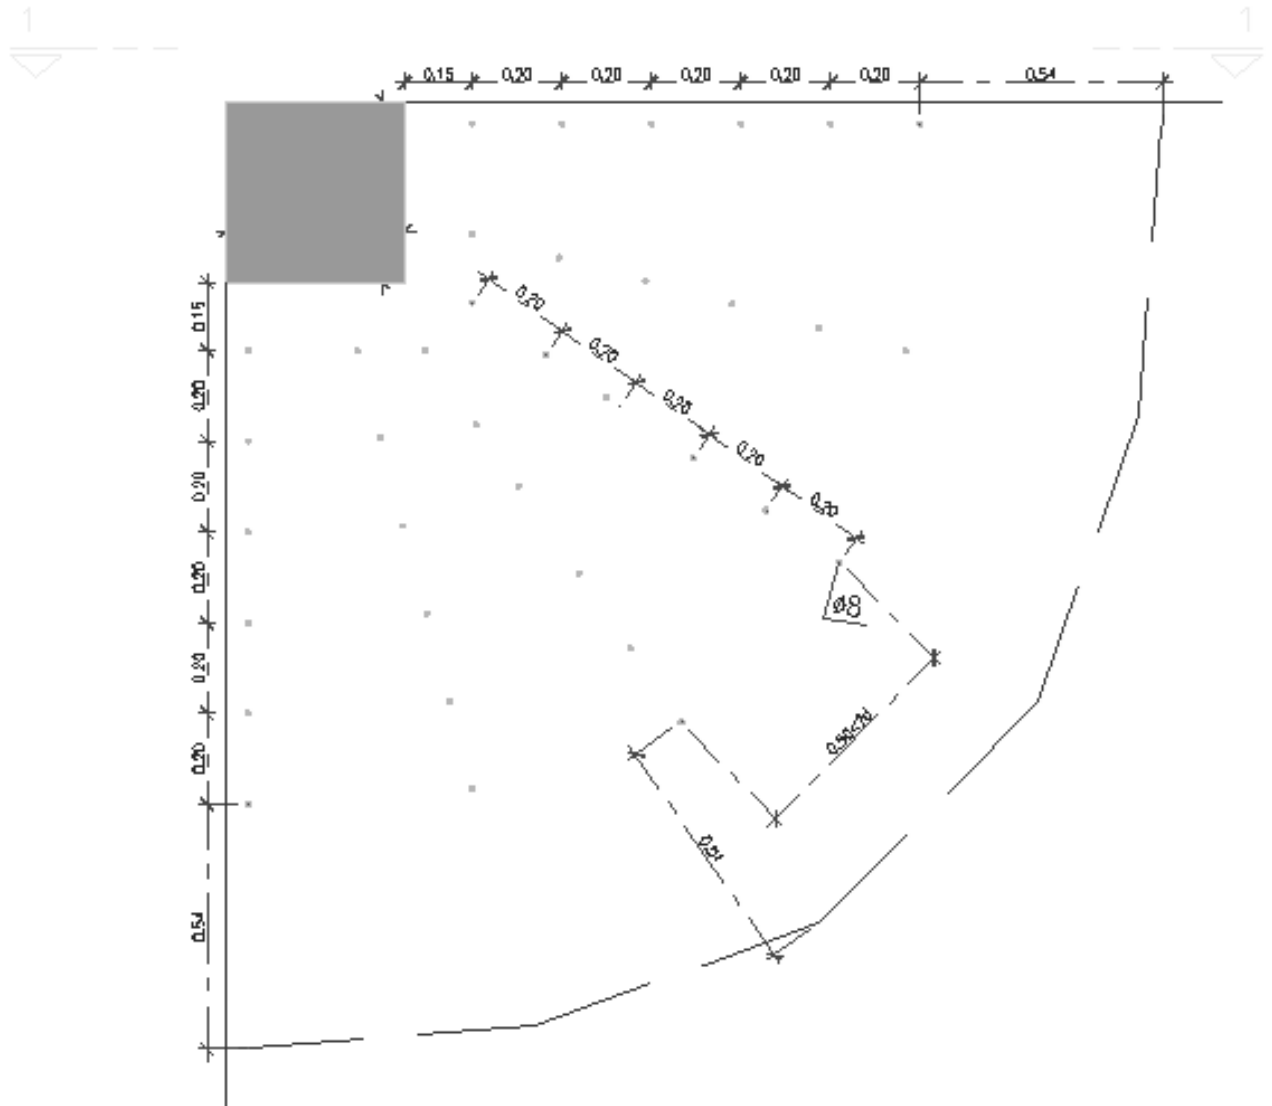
Planta da armadura de punçoamento do caso em análise (pilar de canto P1).
